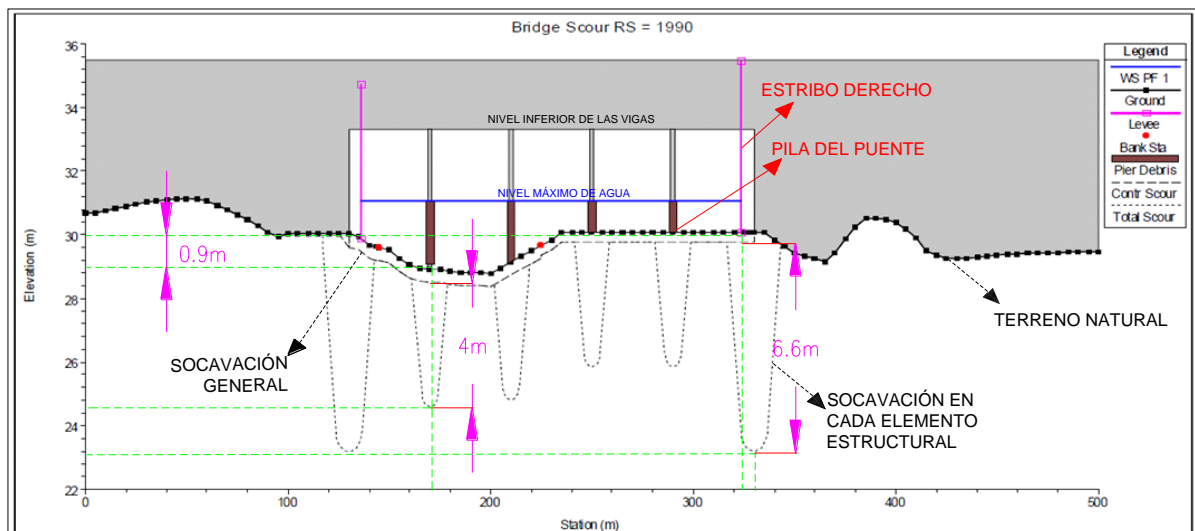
Máxima Socavación en estribos y pilas del Puente Norcay, Modelado por el Equipo consultor 2011 [6]
